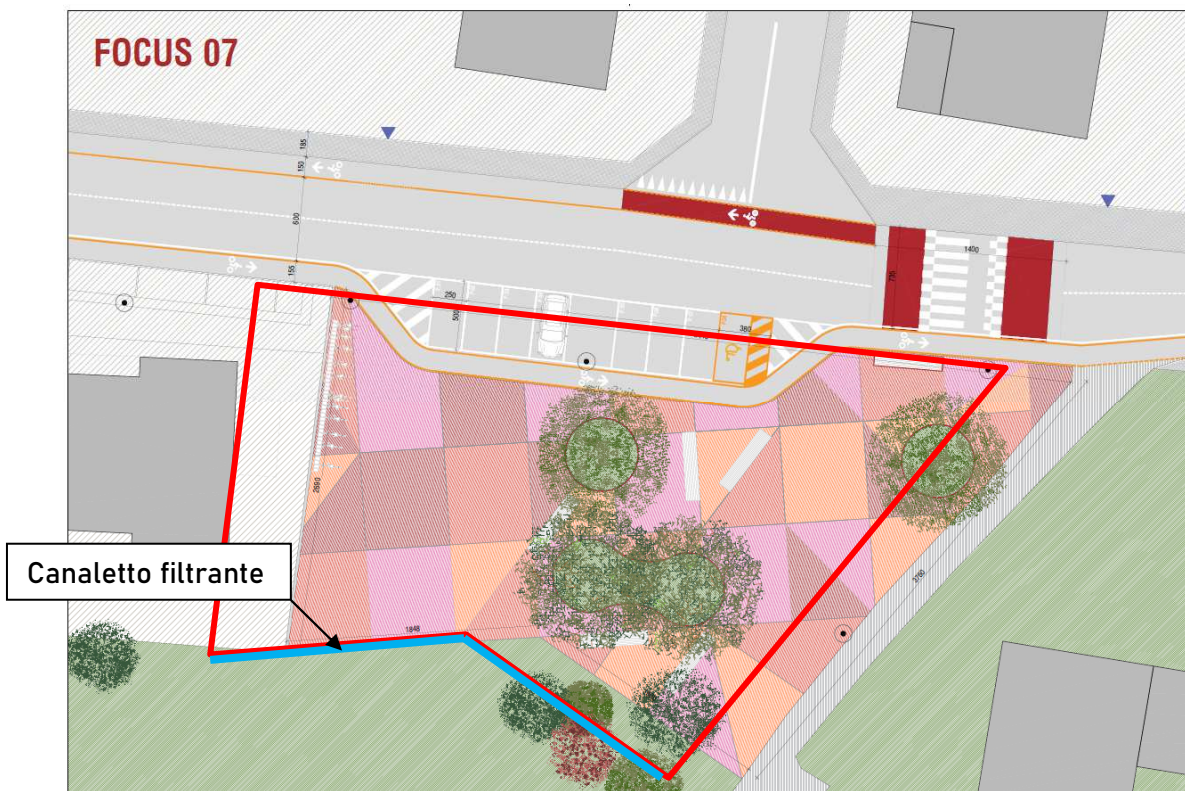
Stato di progetto Focus 07 – in linea continua rossa la pavimentazione prevista
